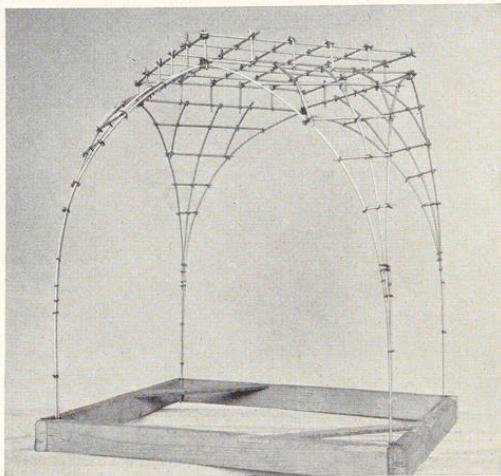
Über Eck gestelltes Kloster gewölbe mit Spiegel auf quadratischem Grundriss
